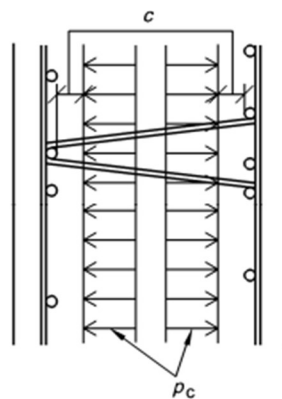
spinta del getto sulle lastre prefabbricate
